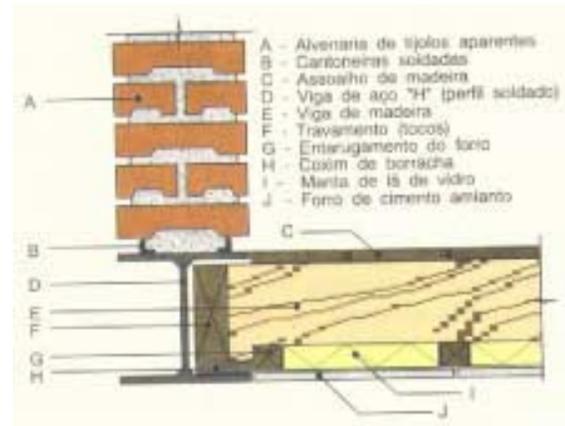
Alvenaria aparente + estrutura metálica – COSTA²¹
